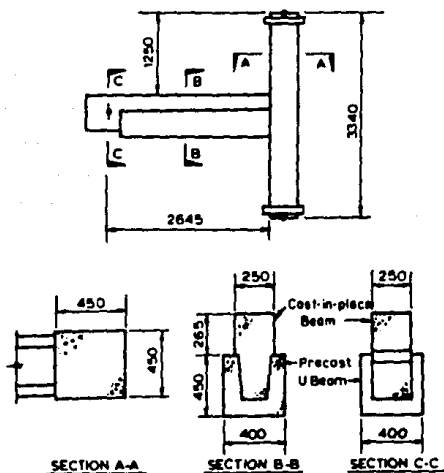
Detalles de construcción de un sistema estructural con traves compuestas.
